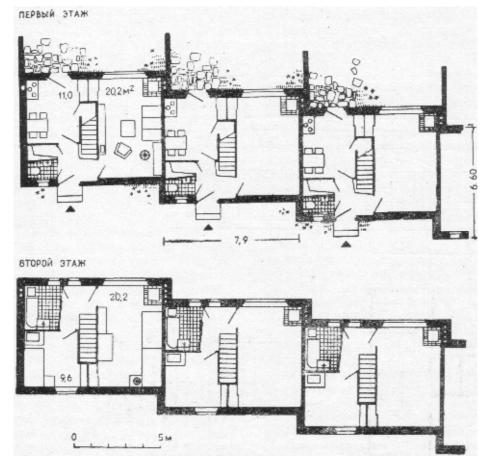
Трехкомнатная квартира блокированного дома (Венгрия) Жилая площадь 55 m^2 . Помимо совмещенного санузла во втором этаже, в первом этаже предусмотрена уборная. Небольшая ширина корпуса и отсутствие входного тамбура позволяют применять данное решение лишь в теплых районах
